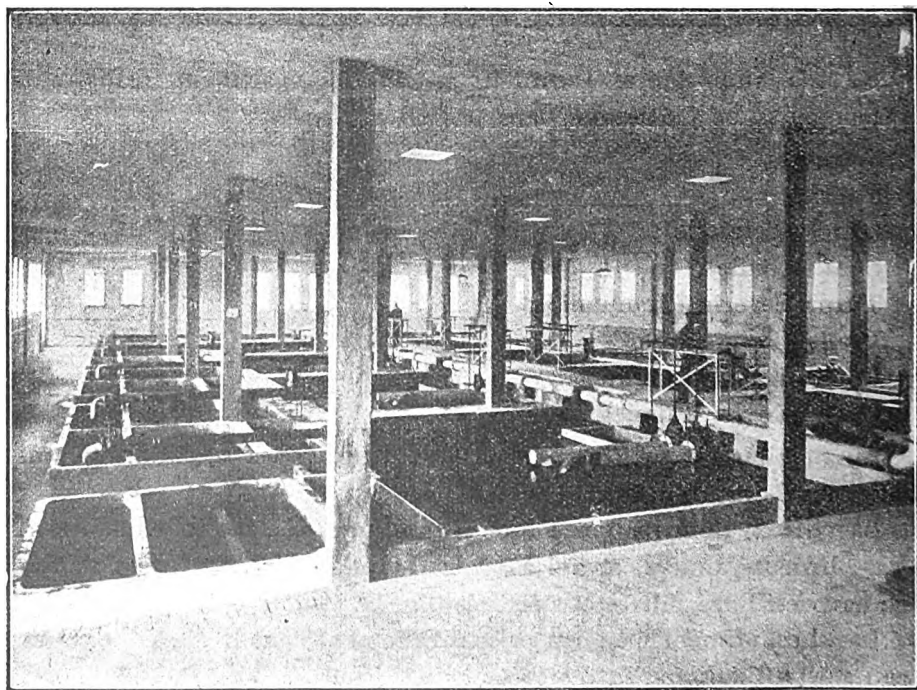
Chartres. — Vue d'ensemble des installations filtrantes.
